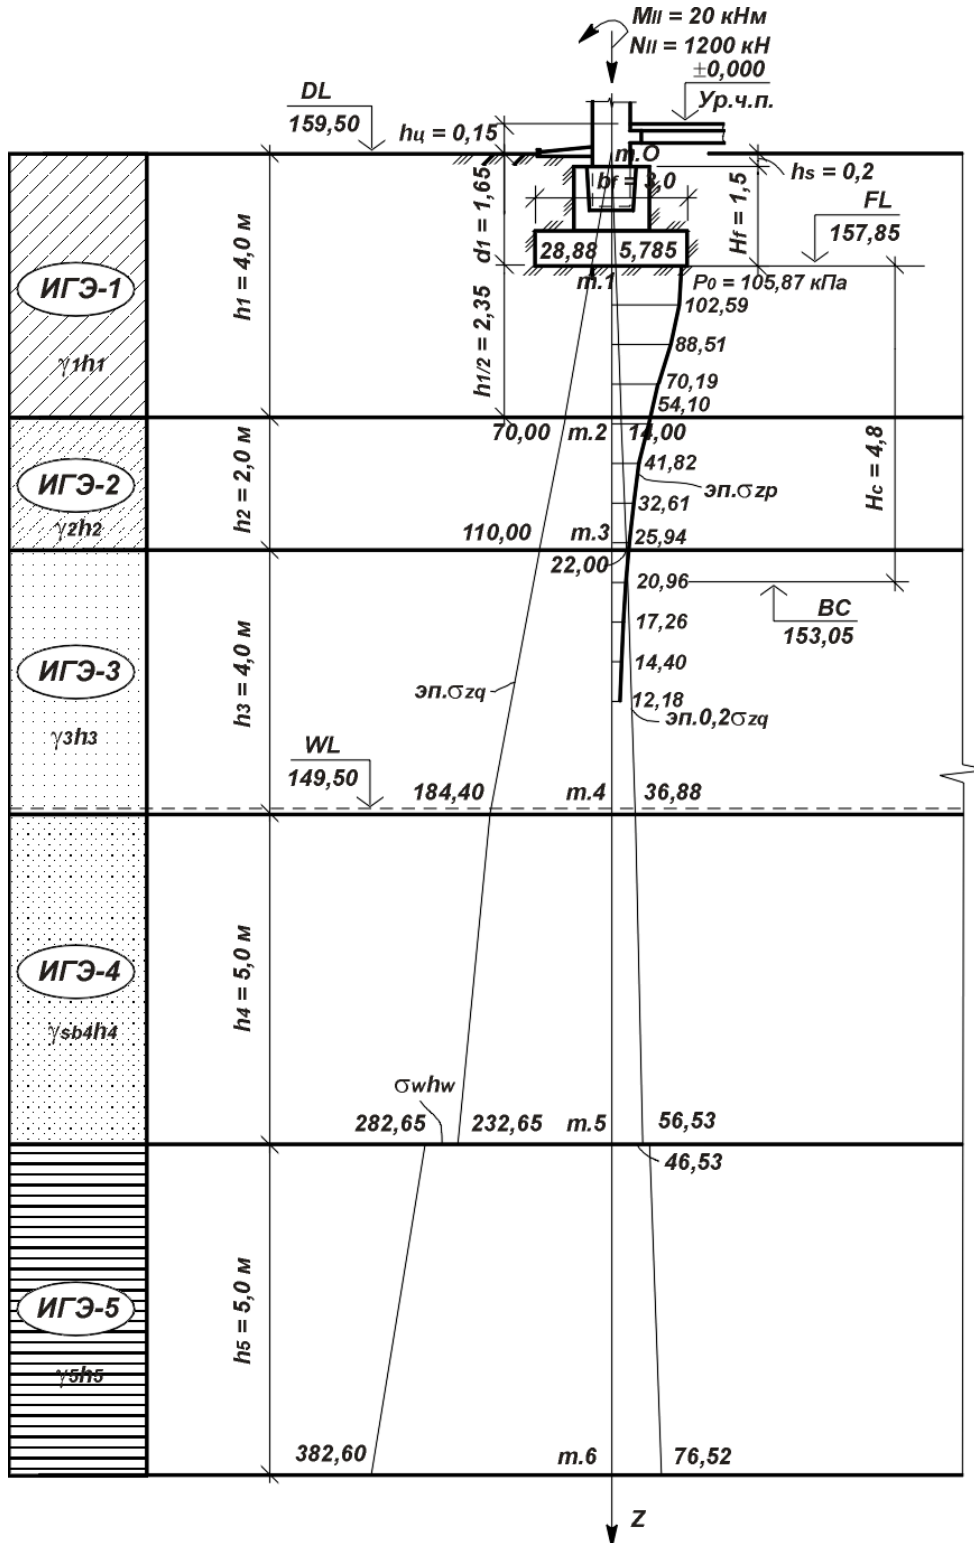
К расчету осадки фундамента ФМЗ-2 в сечении II-II (В-2): DL – отметка планировки; NL – отметка природного рельефа; FL – отметка подошвы фундамента; WL – уровень подземных вод; BC – нижняя граница сжимаемой толщи; H_c – толщина сжимаемой толщи; d_1 – глубина заложения фундамента от уровня планировки; b_f – ширина фундамента; эп. σ_{zg} и эп. $0,2\sigma_{zg}$ – соответственно, основная и вспомогательная эпюры вертикальных напряжений от собственного веса грунта; эп. σ_{zp} – эпюра дополнительного вертикального напряжения от подошвы фундамента
